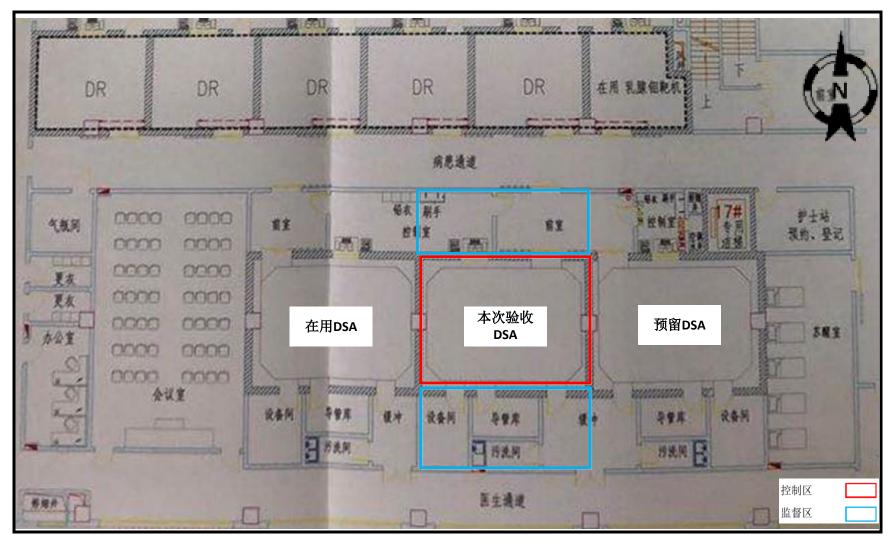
本次竣工环保验收项目 DSA 场所(医技楼一楼)平面布置示意图
